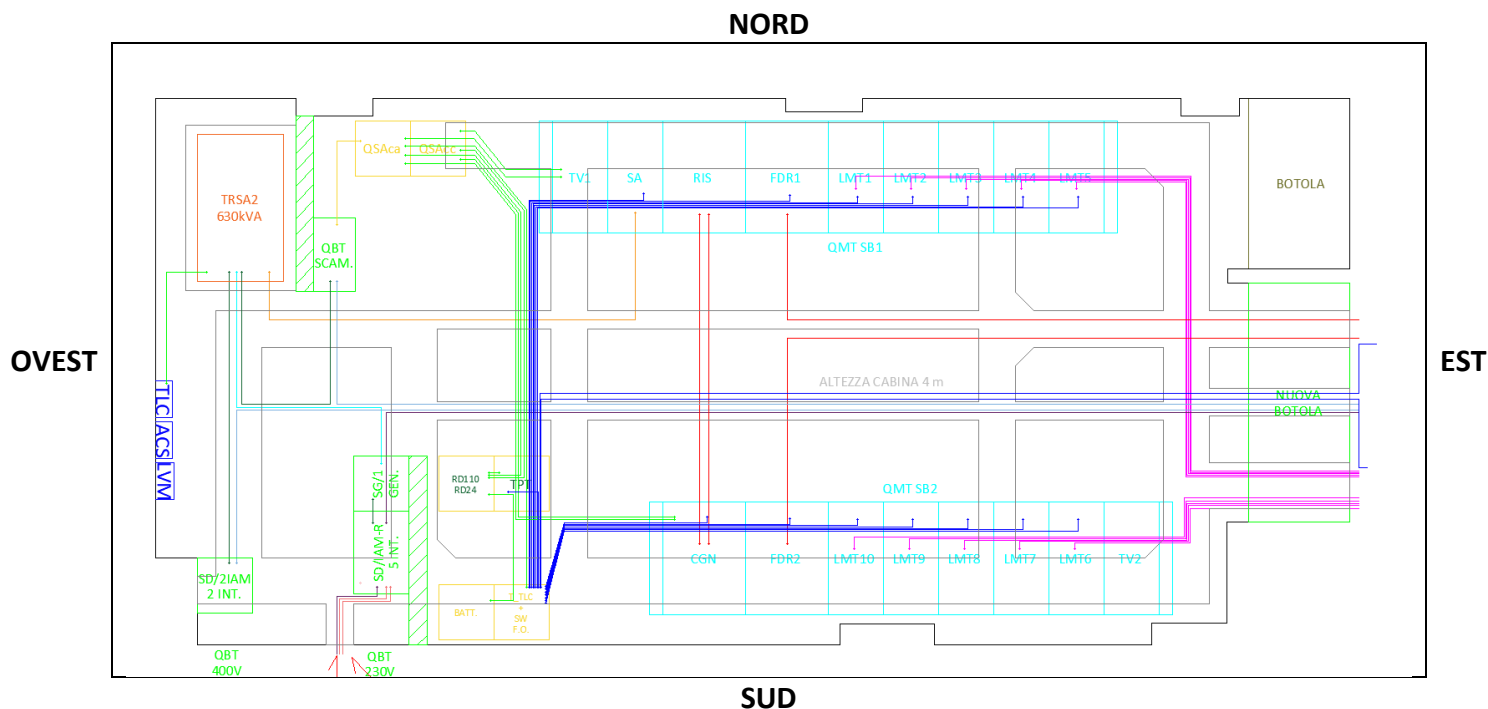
Pianta del locale Cabina Elettrica al piano interrato
